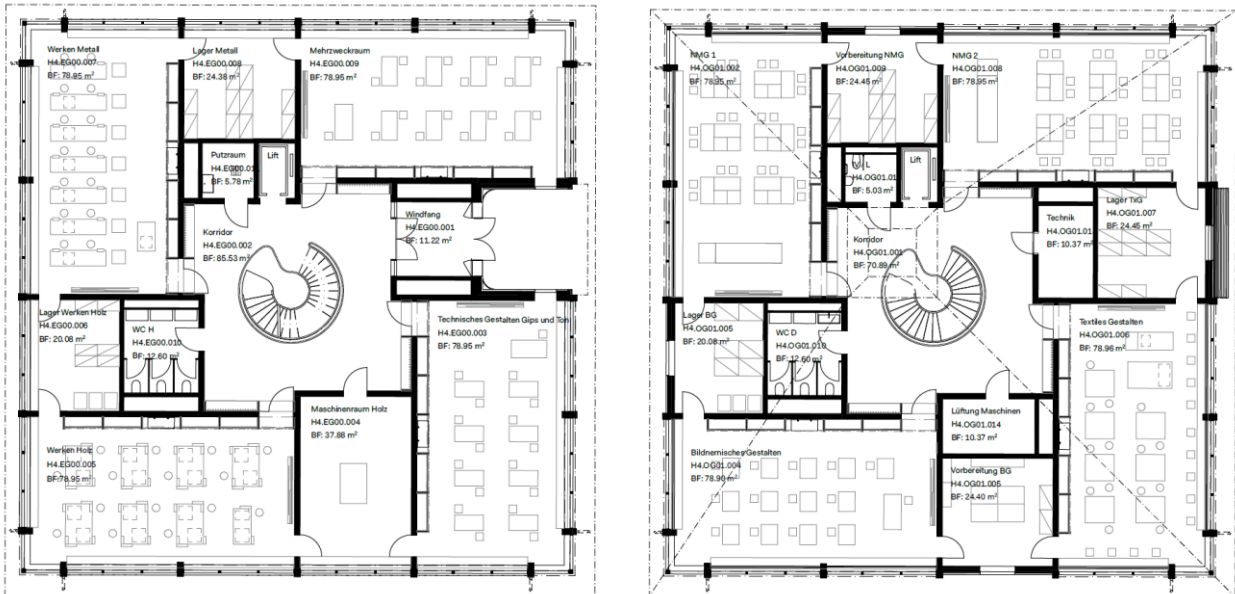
Neubau – Grundrisse Erdgeschoss und Obergeschoss
